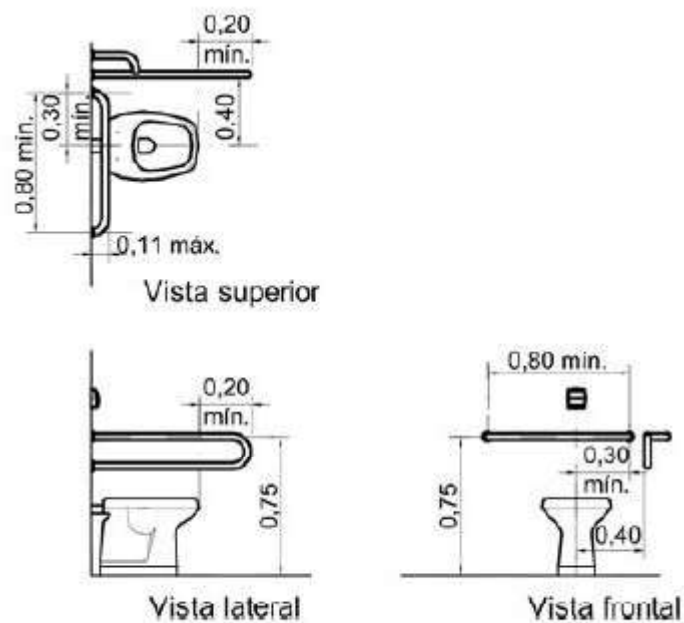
Exemplo de barra de apoio lateral com fixação na parede de fundo.
